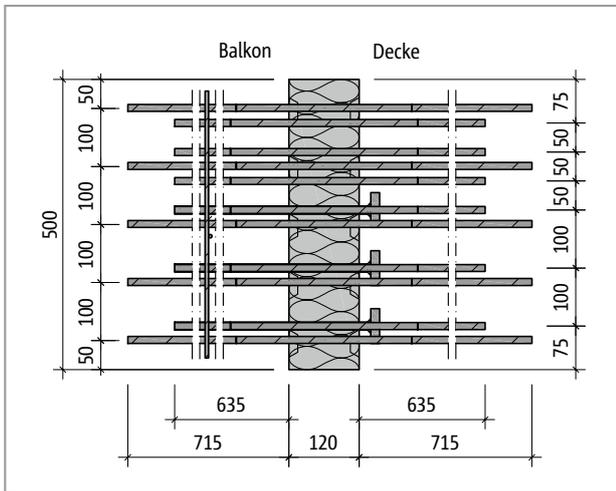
Schöck Isokorb® XT Typ C-L-M2-V2: Produktgrundriss
